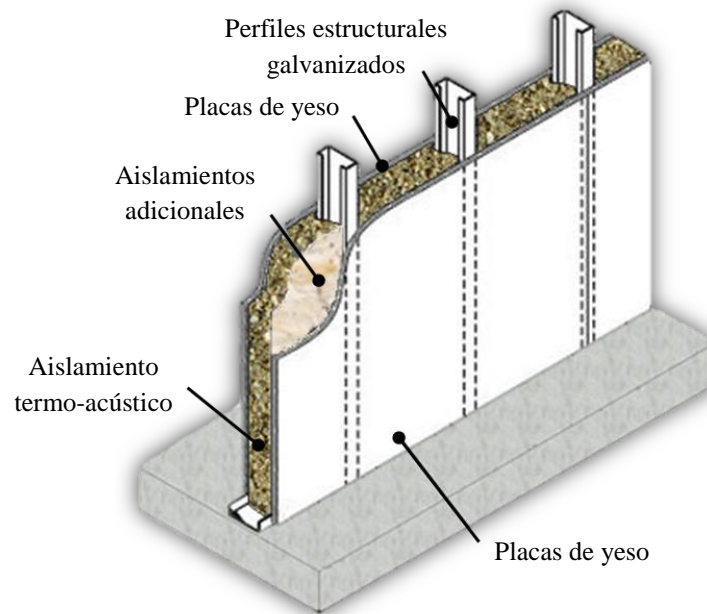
Detalle del sistema drywall de muro interior con adobes de T-C-M como aislamiento.
